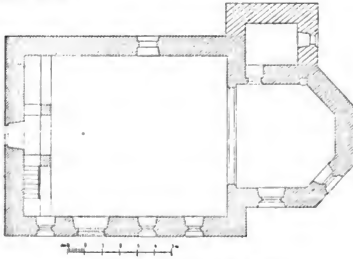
Chomie. Grundriss der Kirche.
